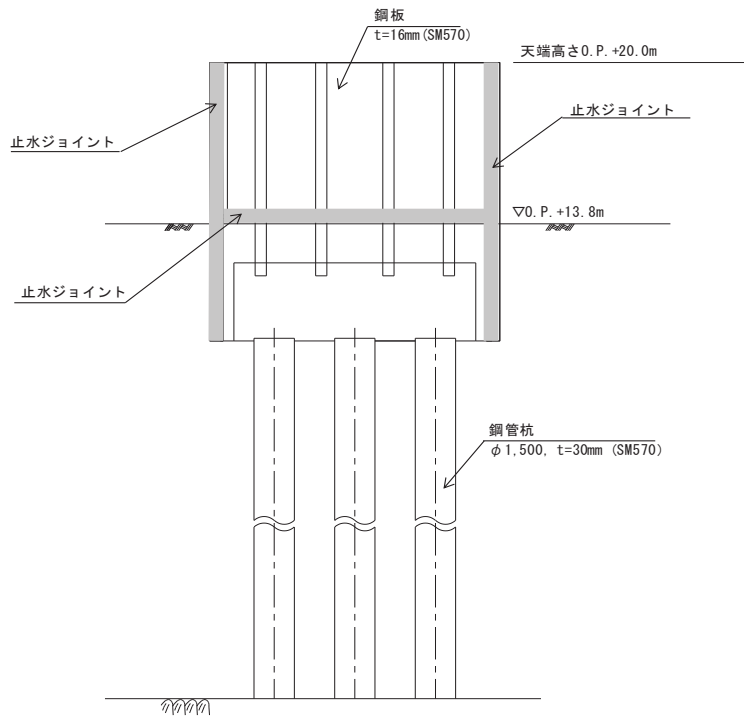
鋼製遮水壁（鋼板） 区間位置図
